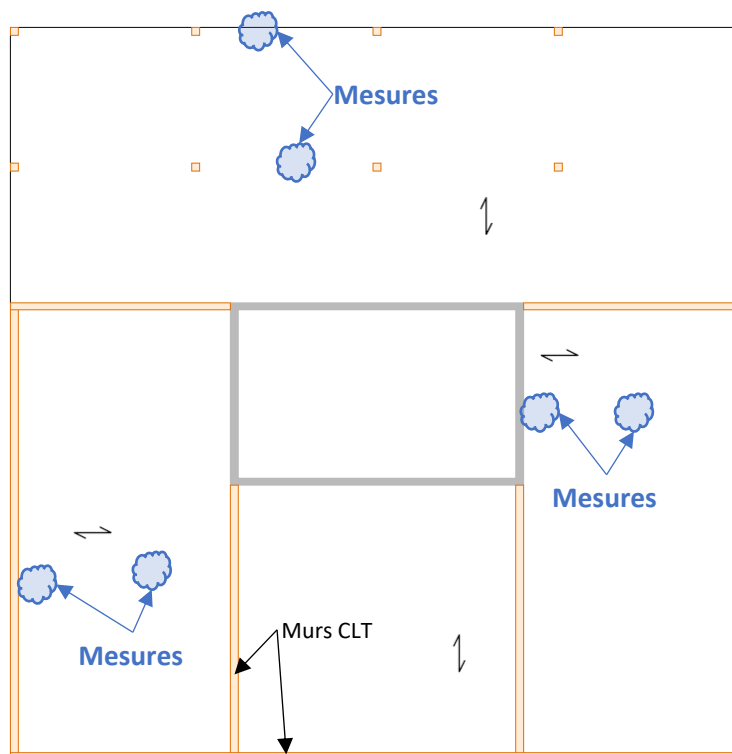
Exemple d'échantillonnage sur un plan d'étage quelconque pour le contrôle de l'humidité des planchers CLT
